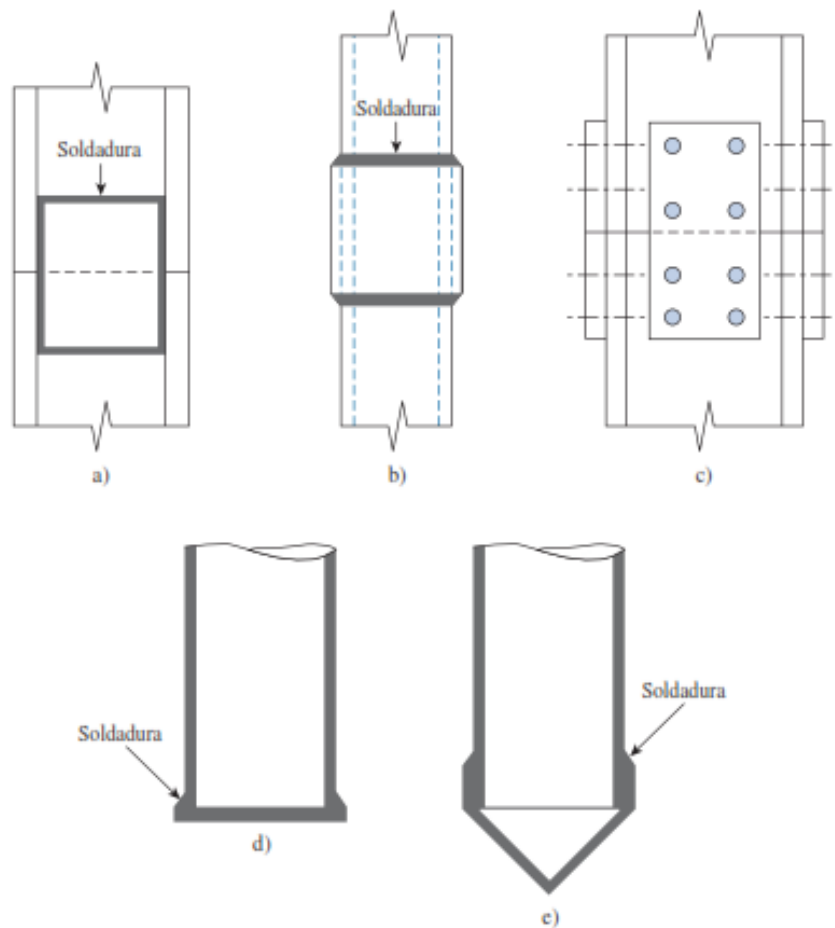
Pilotes de acero: a) empalme de un pilote H con soldadura; b) empalme de un pilote con soldadura; c) empalme de un pilote H con remaches y pernos; d) punta de hincado plana de un pilote de tubo; e) punta de hincado cónica de un pilote de tubo, Adaptado de “Fundamento de ingeniería de cimentaciones”, por Braja M. Das (2012)
